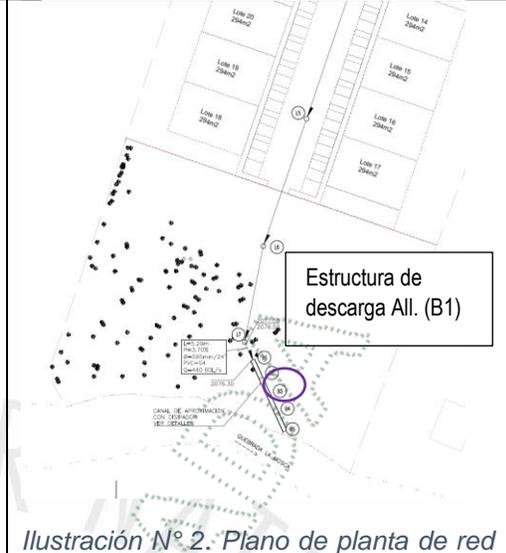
Plano de planta de red de aguas lluvias del proyecto, entregado en radicado CE-11173-2024 del 10 de julio de 2024
